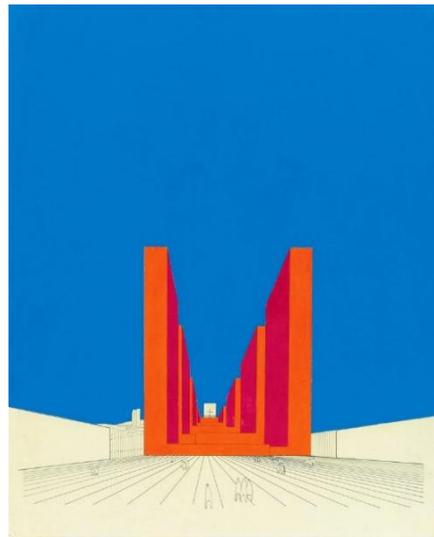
Perspectiva del Zigurat. Fuente: Fundación Barragán.
